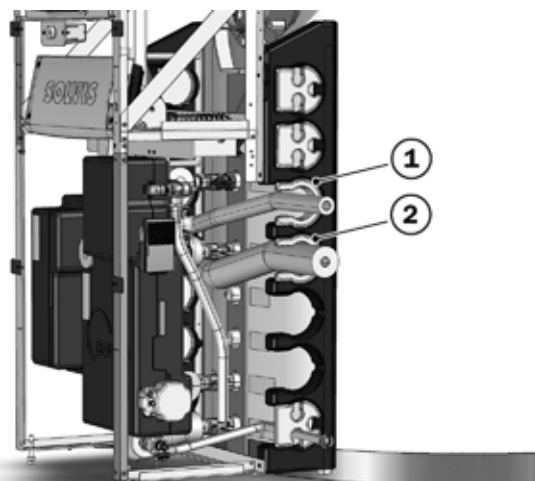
Warmwasserstation, Durchführung Trinkwasserrohre (rechts)
